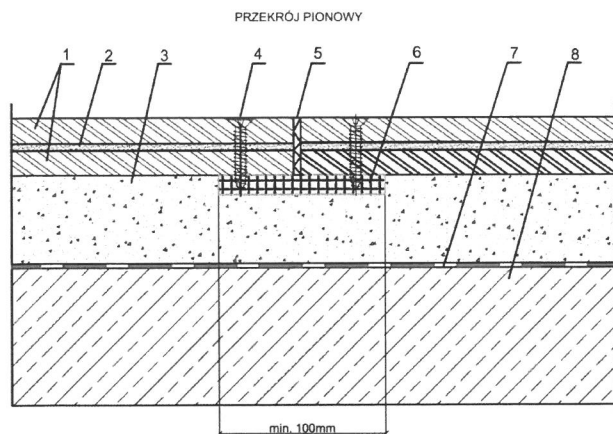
Przekroje przez stropy betonowe/żelbetowe – przykłady rozwiązań
